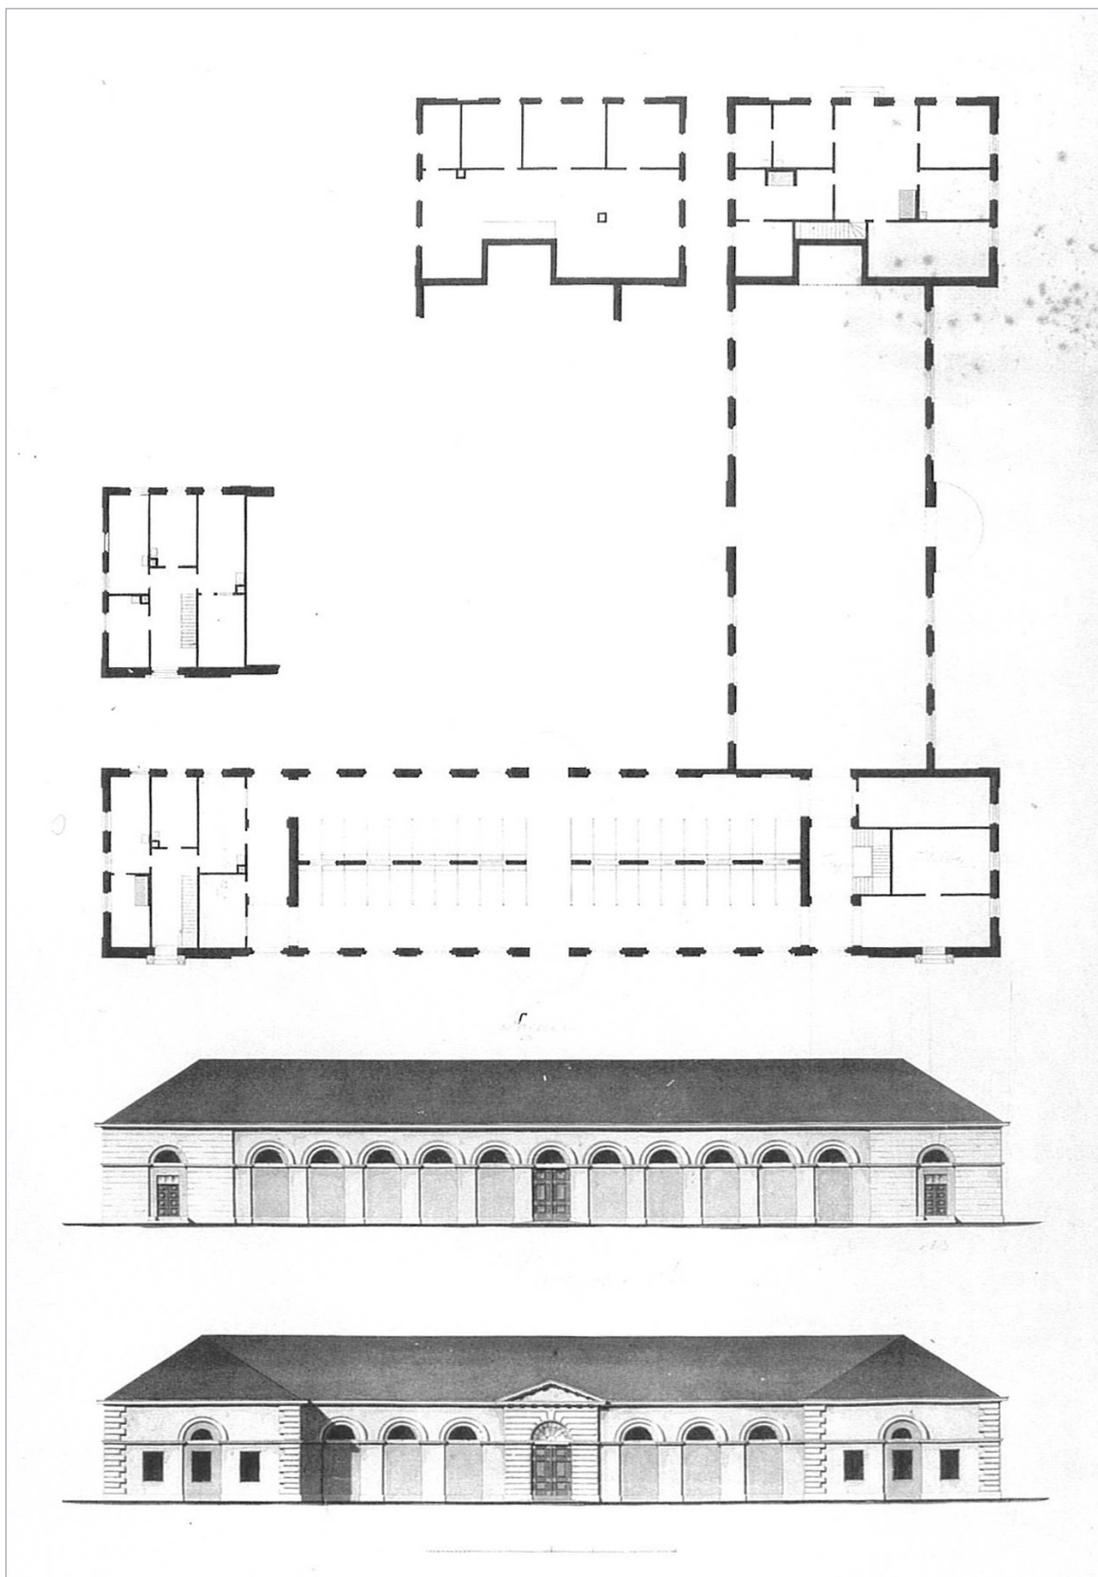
| Historische Grundrisse und Ansichten des Marstalls und der Reithalle
